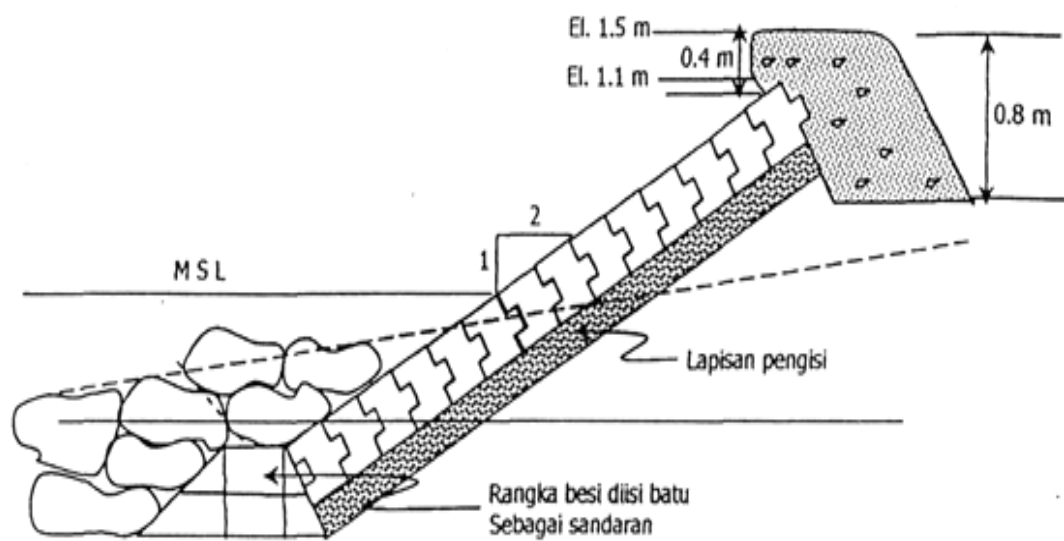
Revetmen dari plat beton bergigi
